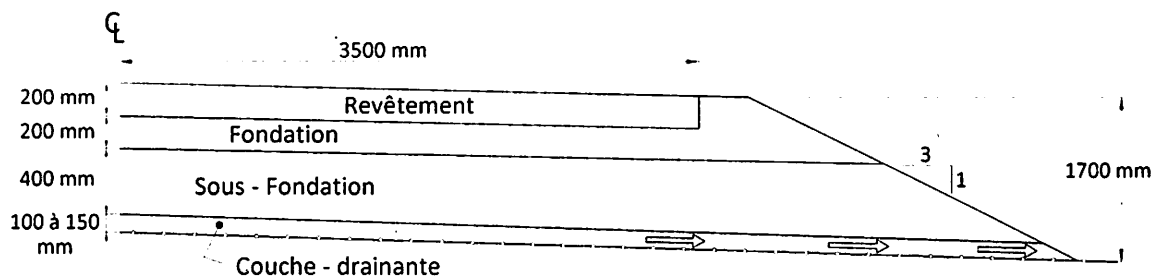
Détail de la structure de chaussée régionale avec profil en coupe.
